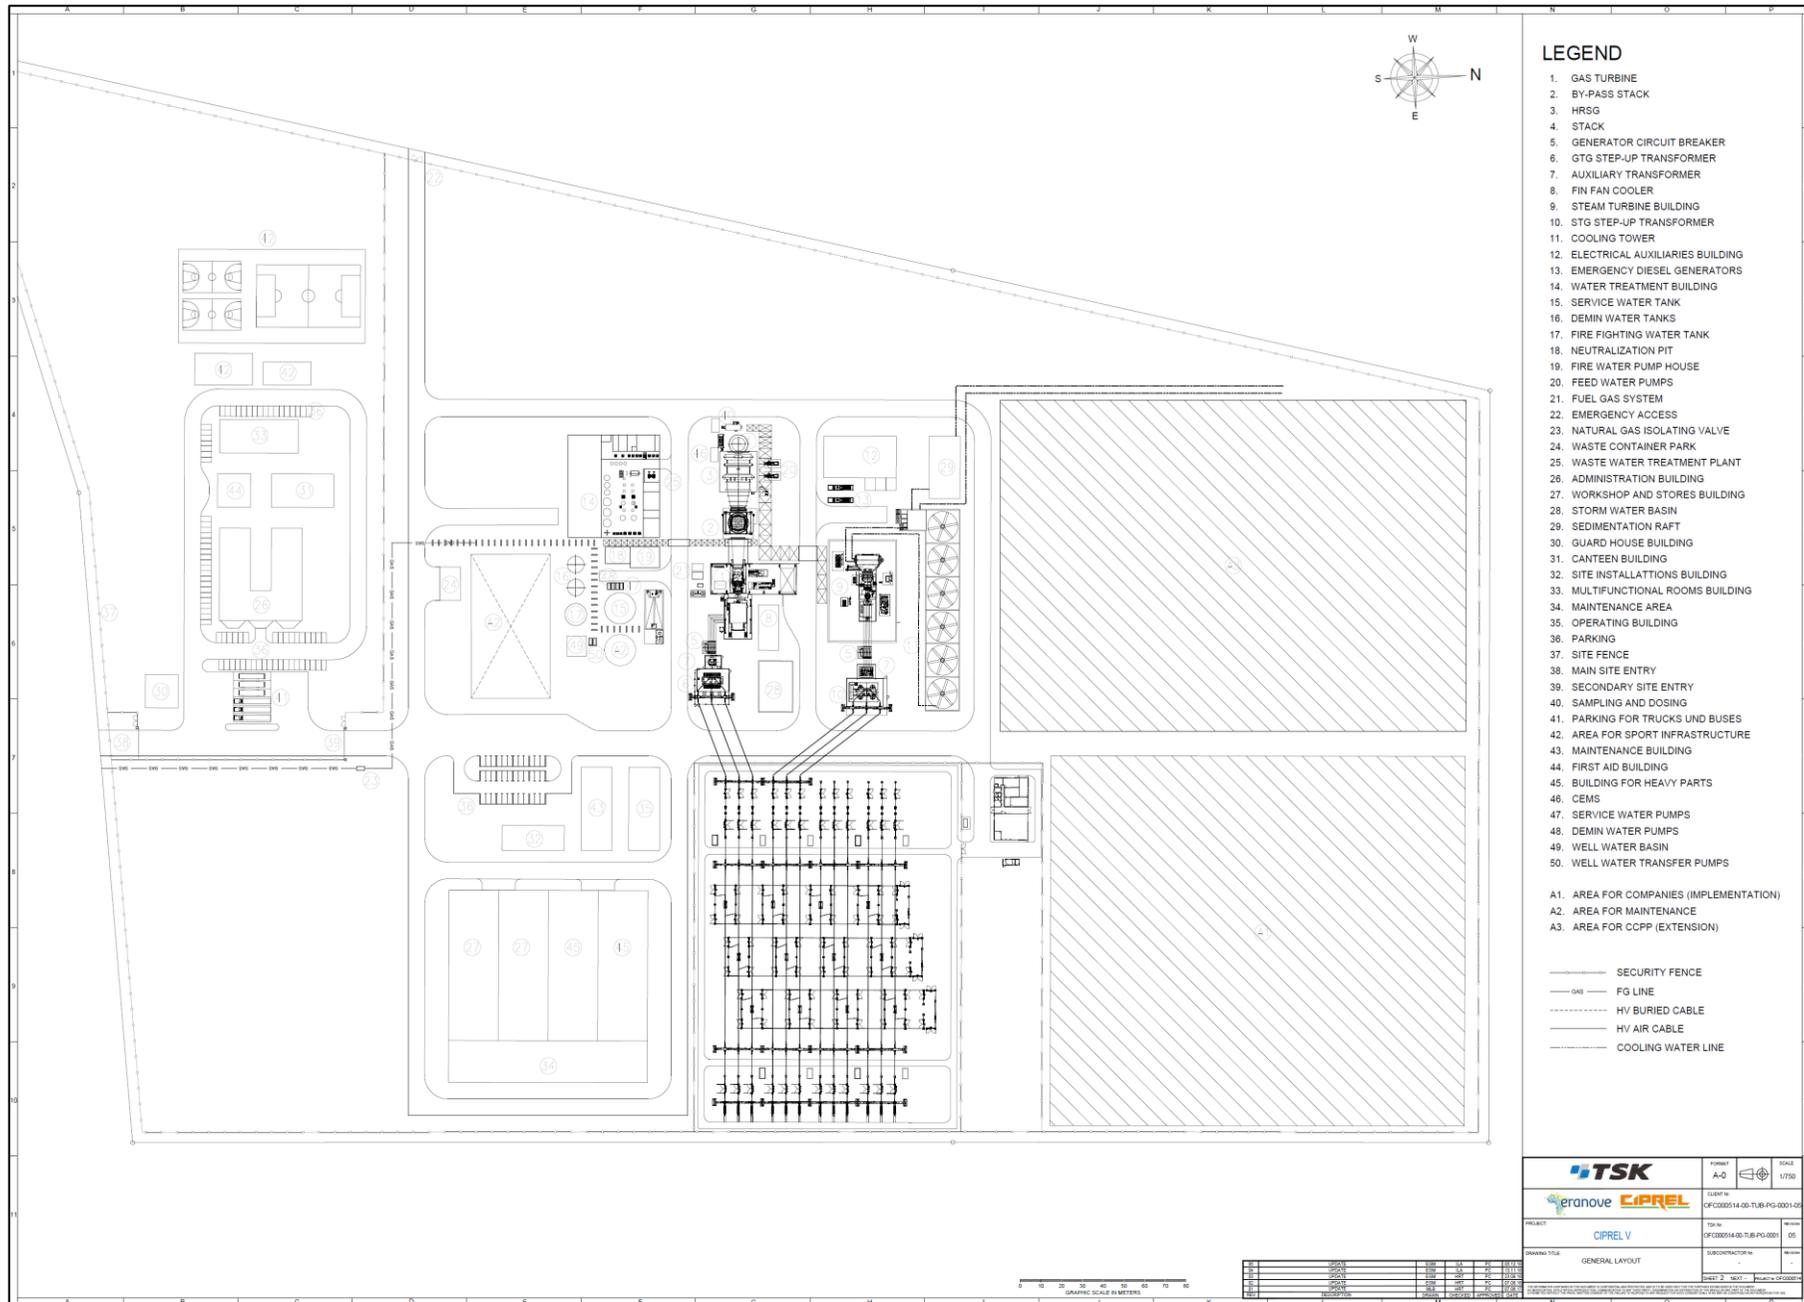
plan détaillé des installations techniques dans l'emprise de la centrale
